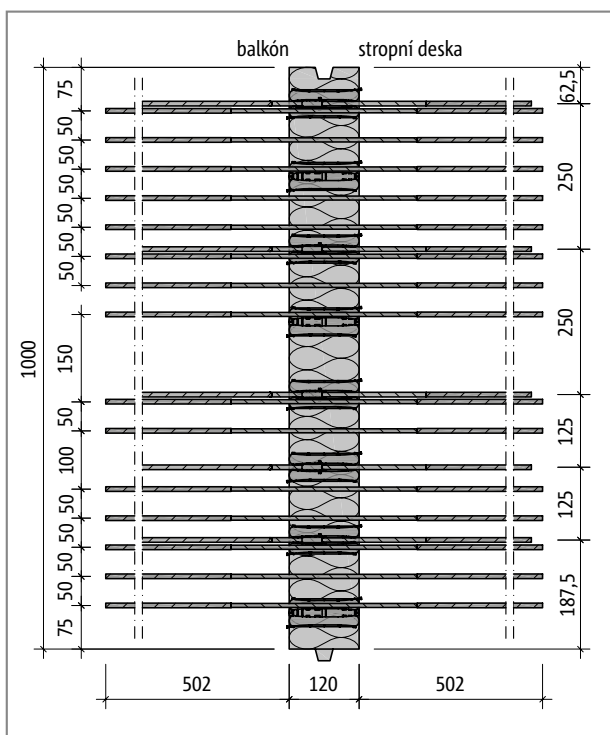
Schöck Isokorb® typ KXT15 až KXT40: Řez prvkem
